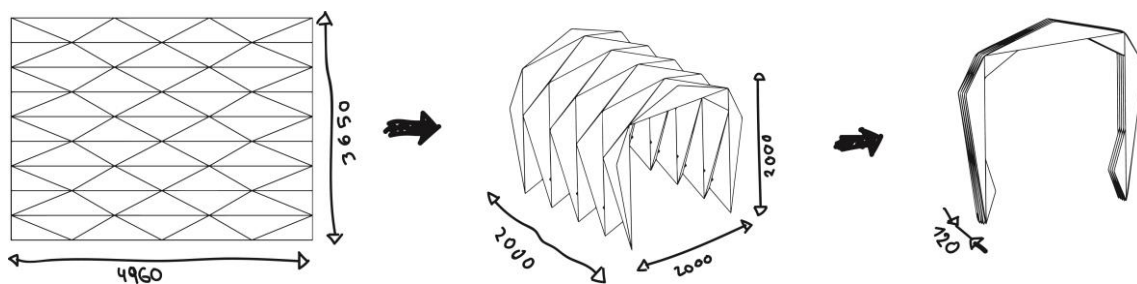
Dibujo de las dimensiones de la estructura plegable
